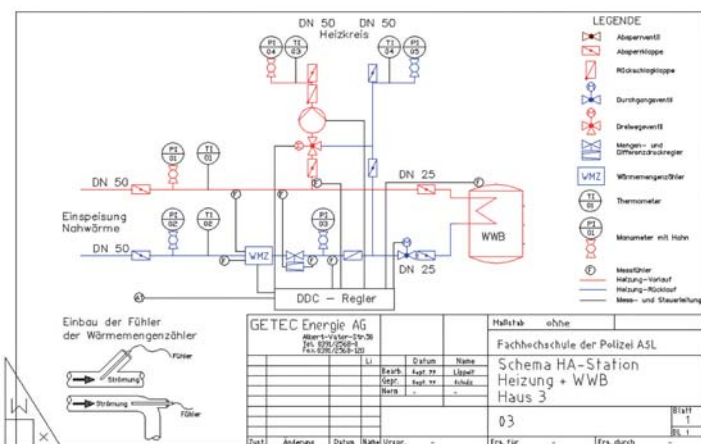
Ursprünglich geplanter Anlagenaufbau.
